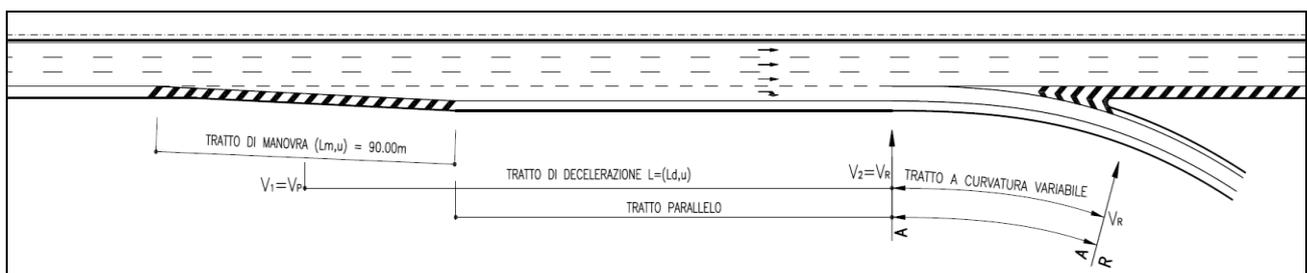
SCHEMA PLANIMETRICO DELLA CORSIA DI DIVERSIONE
